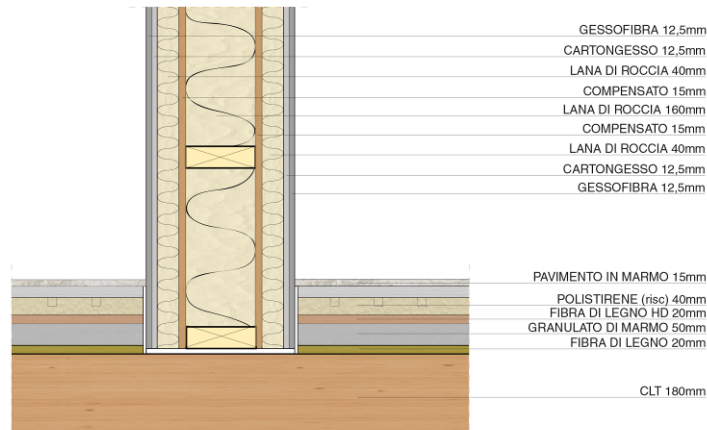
Dettaglio costruttivo della parete divisoria con il solaio - Floor and separation wall structural junction detail.
